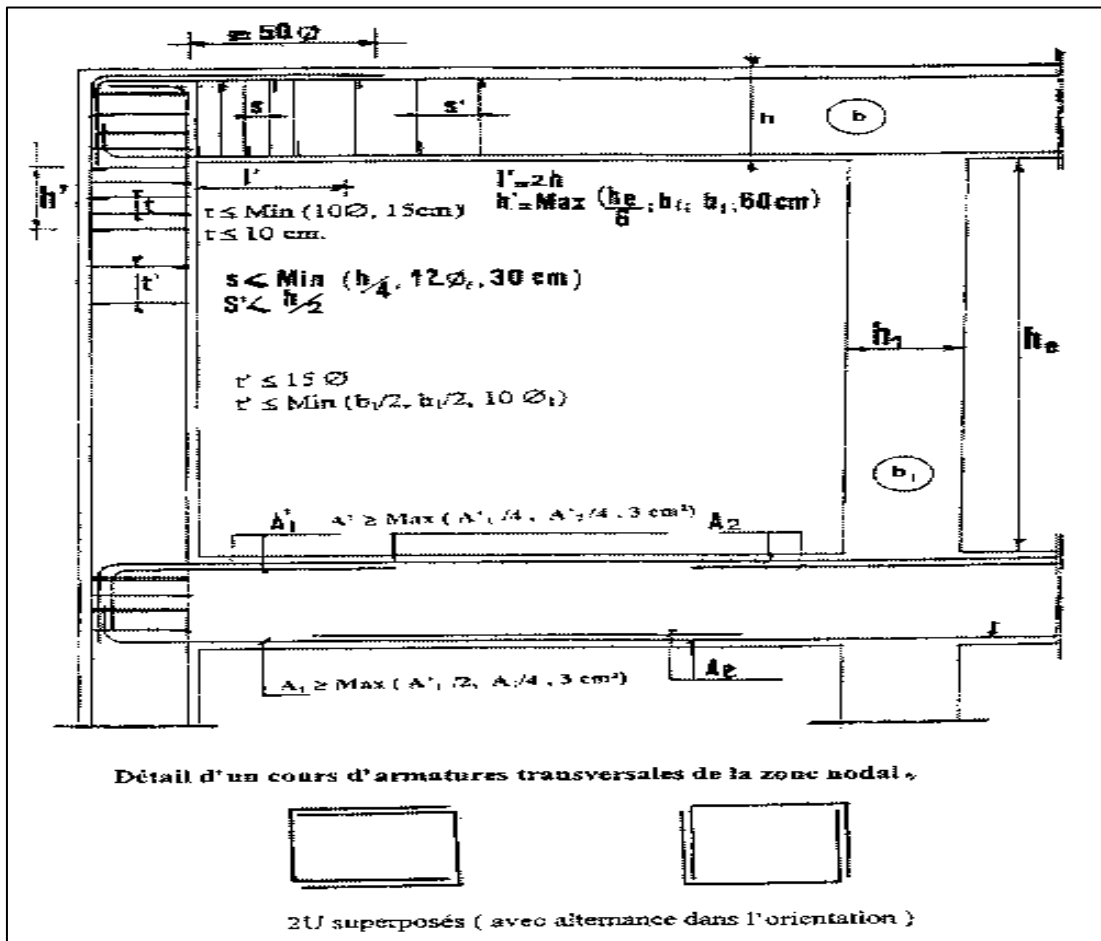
Disposition constructives pour les poutres selon R.P.A99/03
